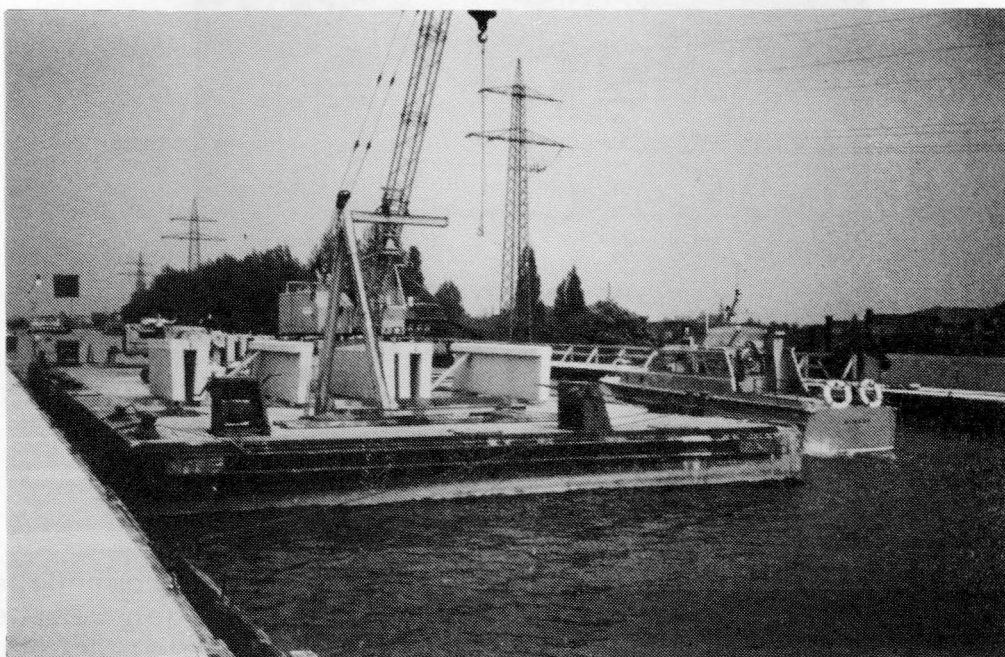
Einbau der Brüstungselemente mit Hilfe eines Schwimmkrans
